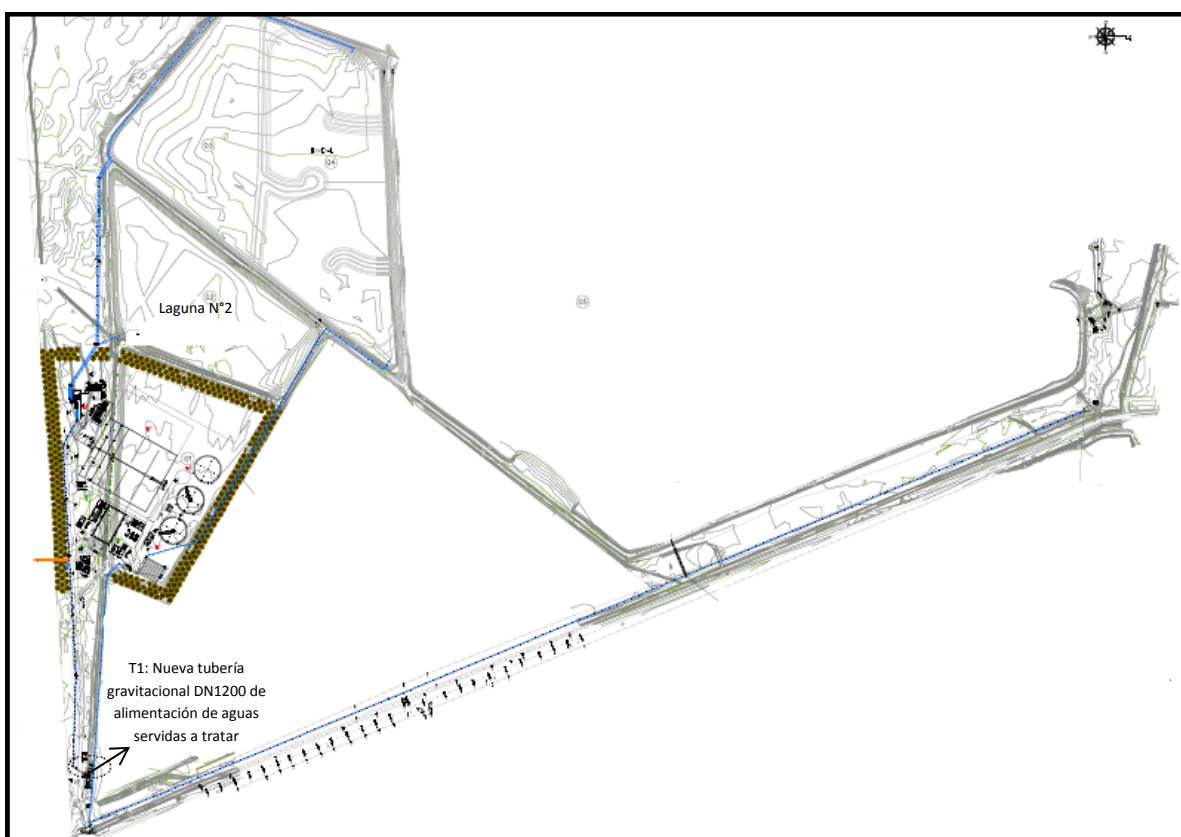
Plano de la planta general del proyecto, las excavaciones de la colindancia a laguna 2, los pozos de cámara y la zanja para la tubería T1, se centraron en el sector Sur de la planta.
